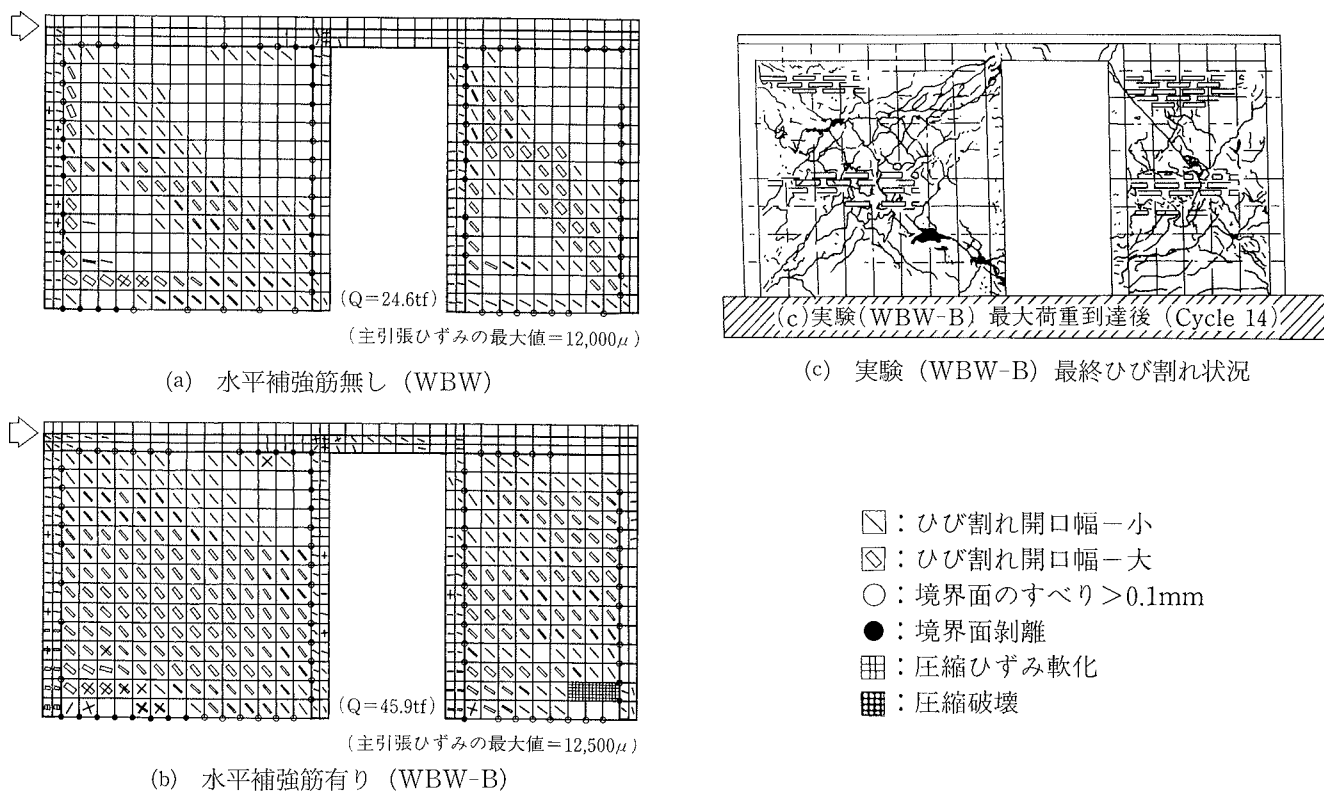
水平補強筋の有無によるひび割れパターンの違い
